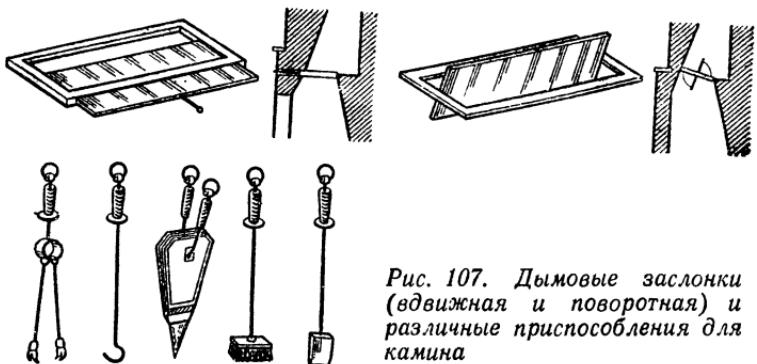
Дымовые заслонки (движущая и поворотная) и различные приспособления для камина
